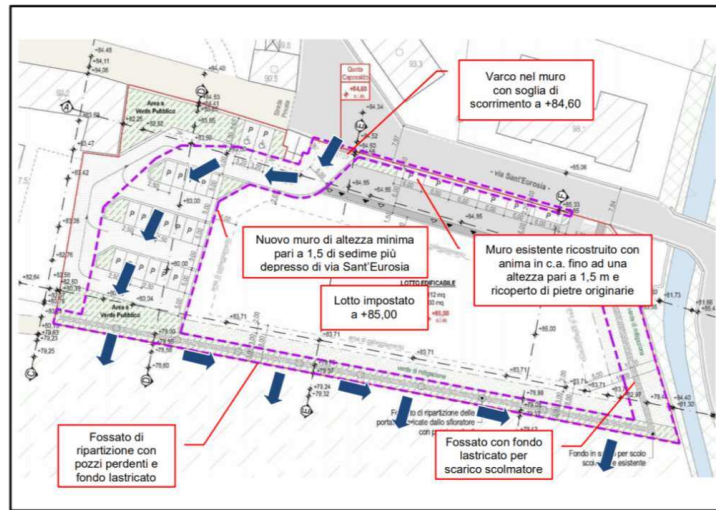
Via S. Eurosia - Planimetria di progetto
